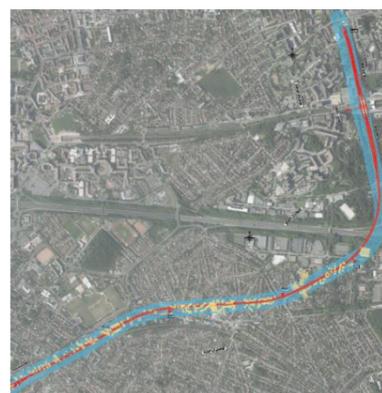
Tracé en plan Ouvrage débranchement SMR/NCH, 2/2
